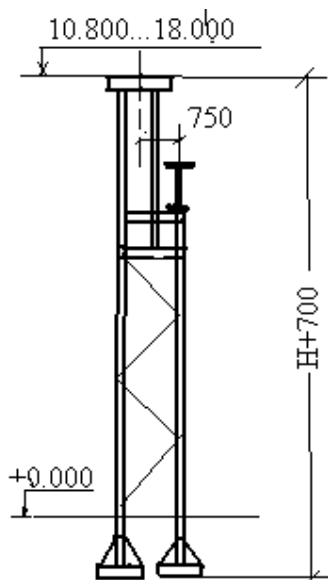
Крайняя сквозная стальная колонна под мостовой кран
